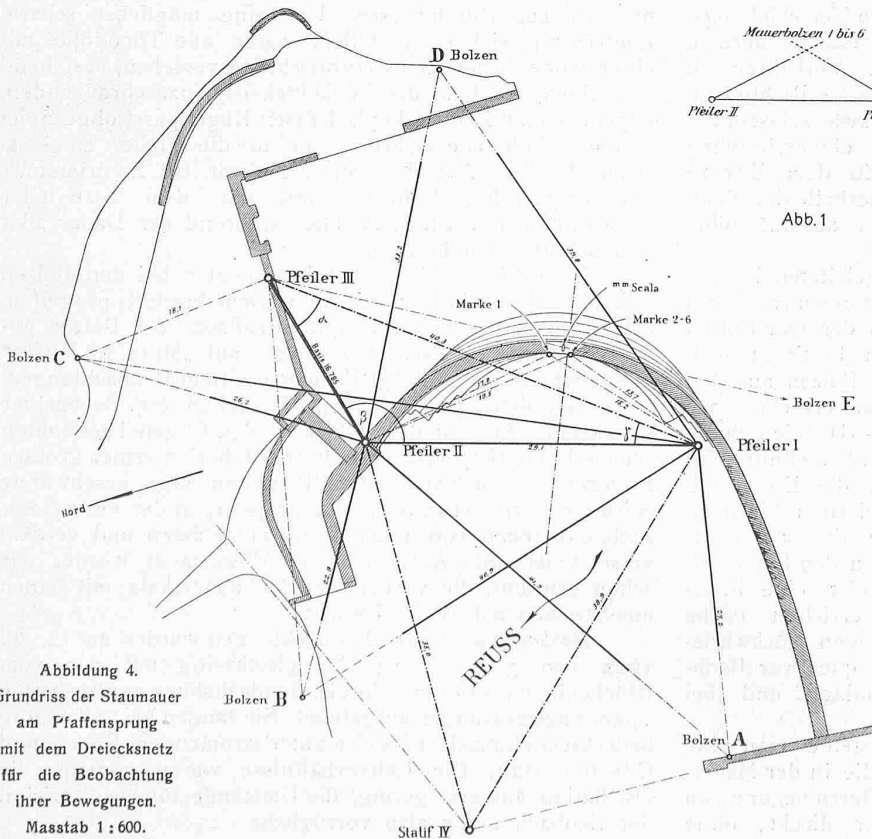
Grundriss der Staumauer am Pfaffensprung mit dem Dreiecksnetz für die Beobachtung ihrer Bewegungen. Masstab 1 : 600.
